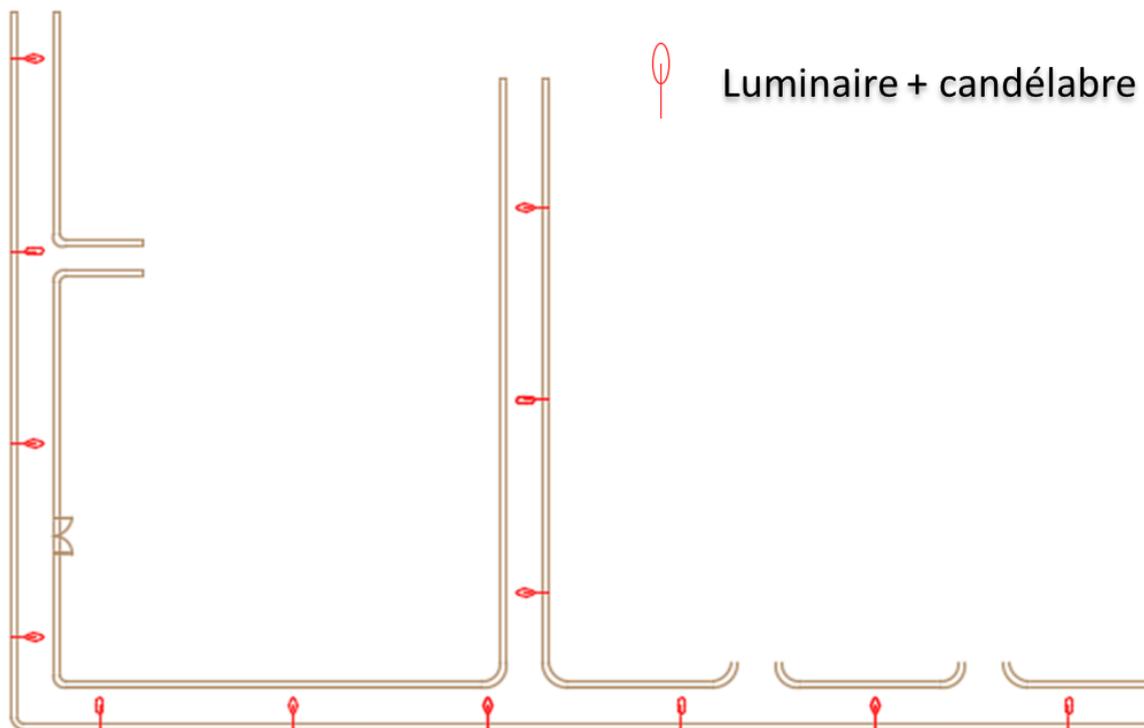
Vue de haut de la chaussée de l'extension de la STÉ de Ziga
